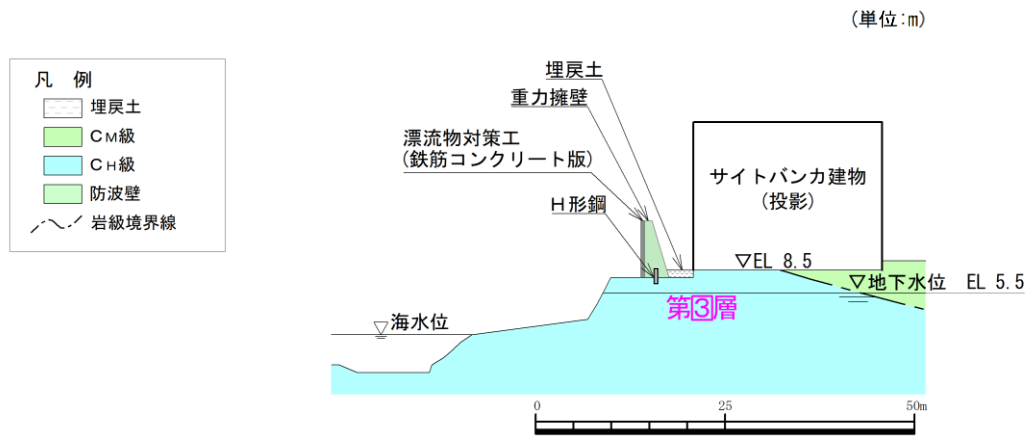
防波壁（波返重力擁壁）の横断面図（⑤-⑤断面）
